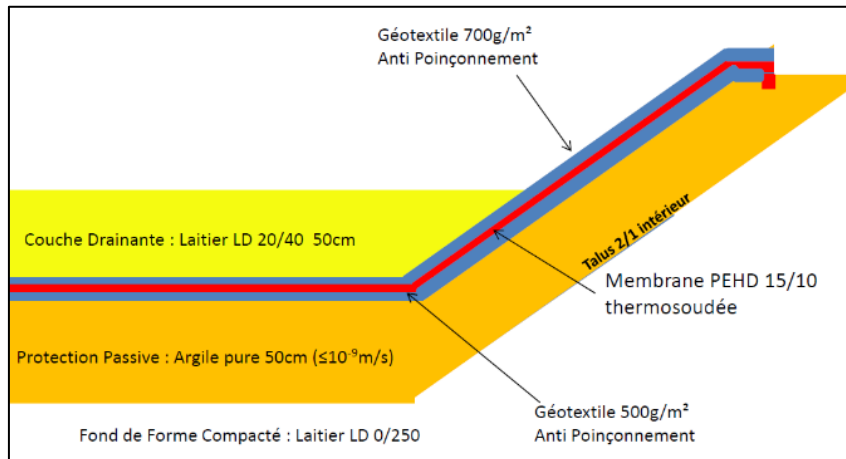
Plan de principe de l'étanchéité du casier L10 – Hors échelle
